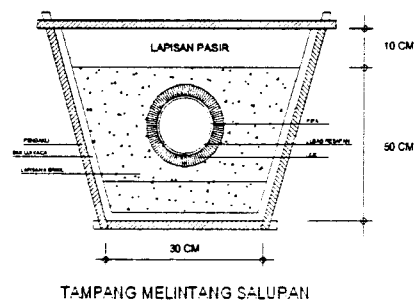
b Potongan melintang model pipa berporasi (resapan)
